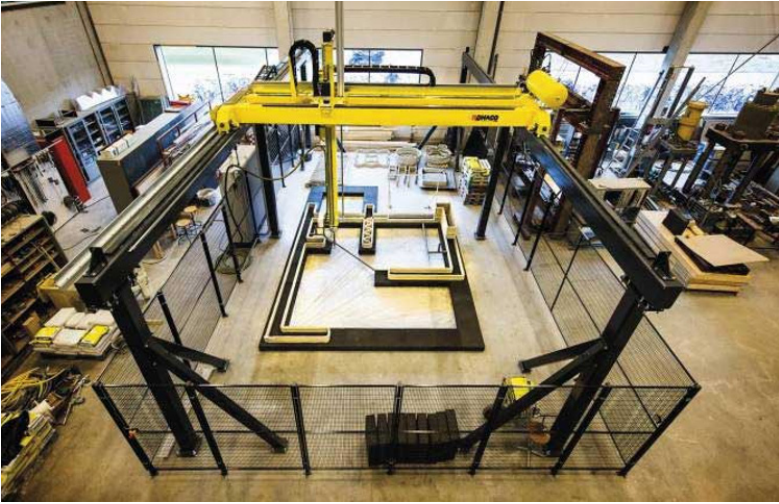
Impresión 3D en hormigón. Fuente: Hormigón al Día, 2021.
